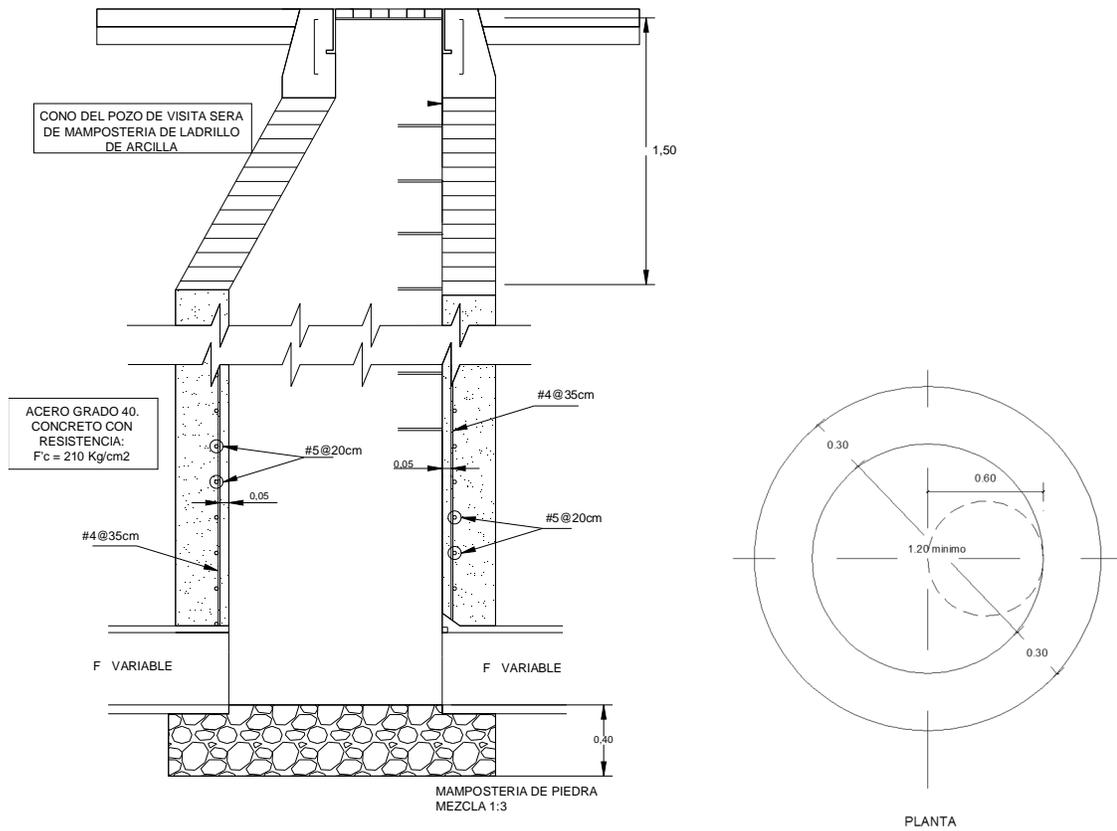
Detalle de pozo de visita (estructural) de aguas lluvias.
